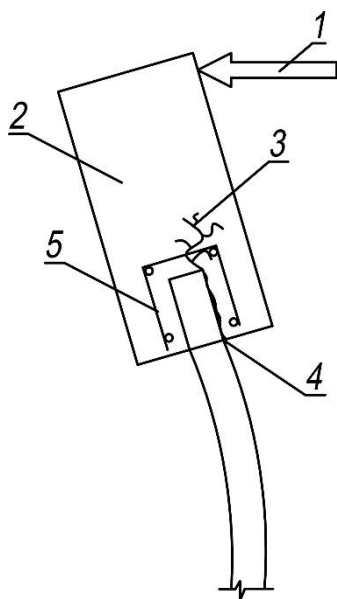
Зона образования трещин в интегральном устое: 1 - направление силы сжатия; 2 – тело устоя; 3 – прогрессирующие трещины; 4 - формирование трещины в месте соединения сваи с бетоном; 5 – дополнительное армирование
